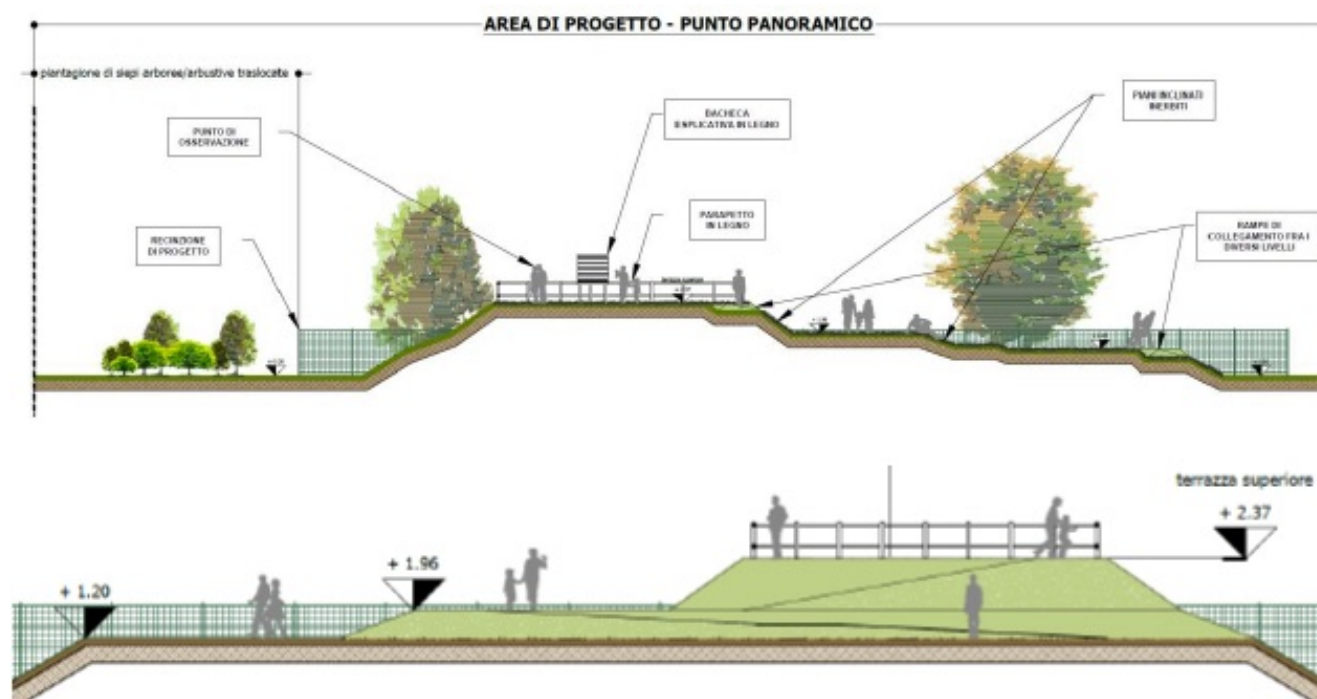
Particolare della sezione e prospettiva della collinetta dell'osservatorio.
